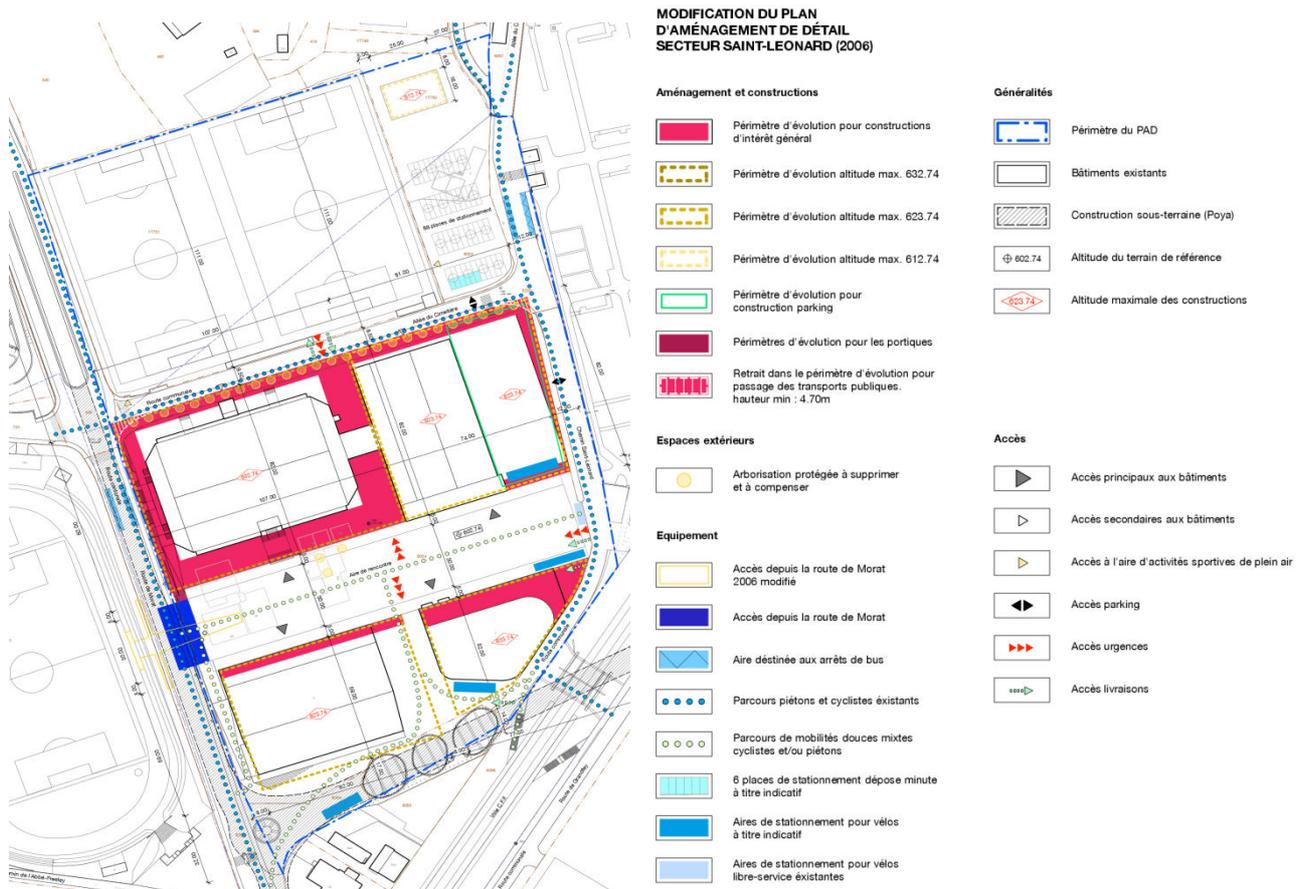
modifications du PAD : extension des périmètres d'évolution pour la P1, la P2 et le parking. Plan
